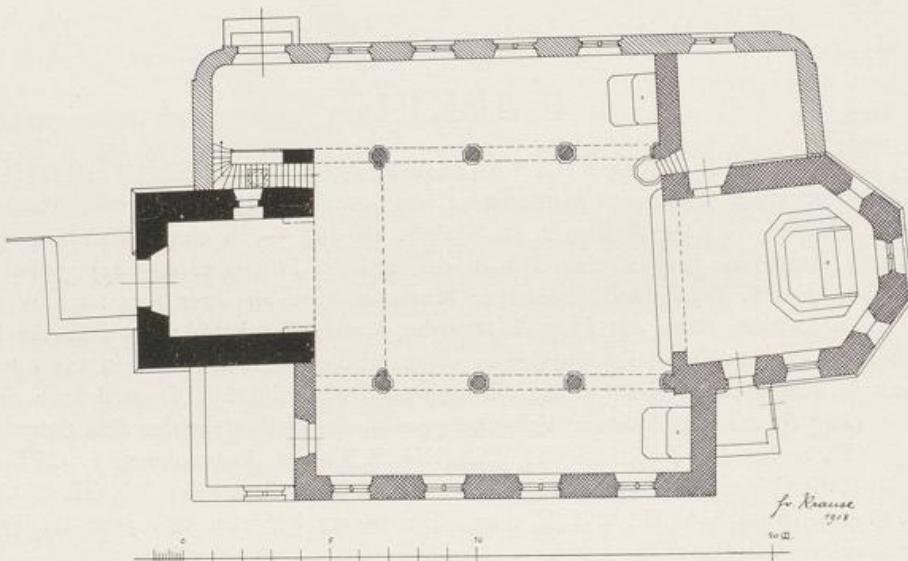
Embken. Grundriss der kathol. Pfarrkirche.
